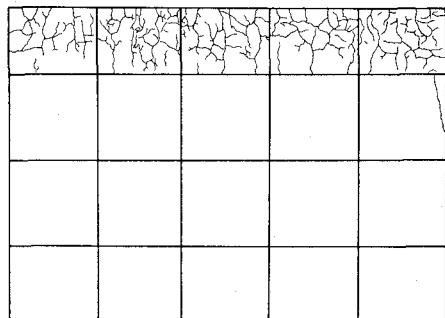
ひびわれ調査図(施工後4ヶ月)
